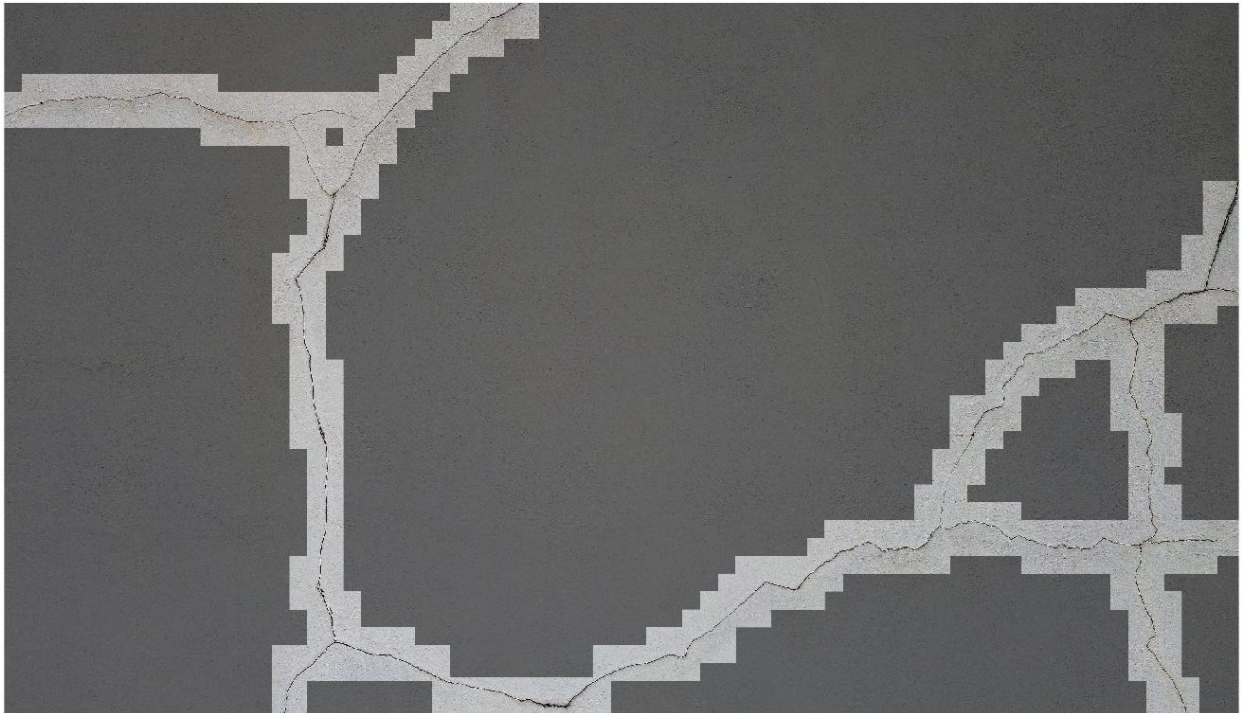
Detecção Fissura Z.F.09
